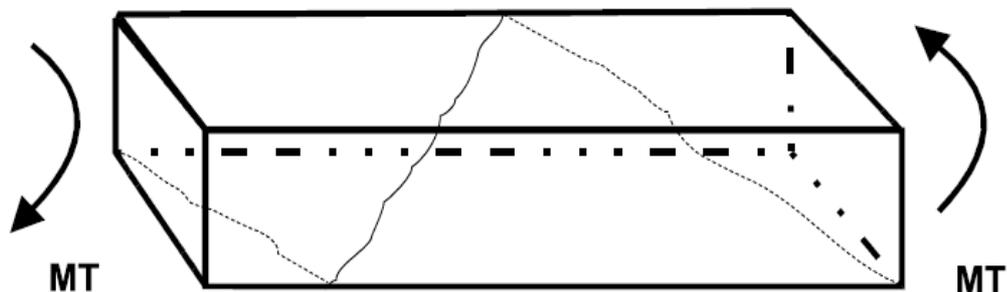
Configuração da fissuração por efeito de torção
